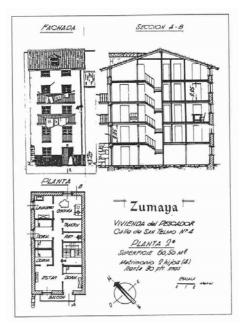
Planta, alzado y sección de una casa de pescadores de los años cuarenta.
